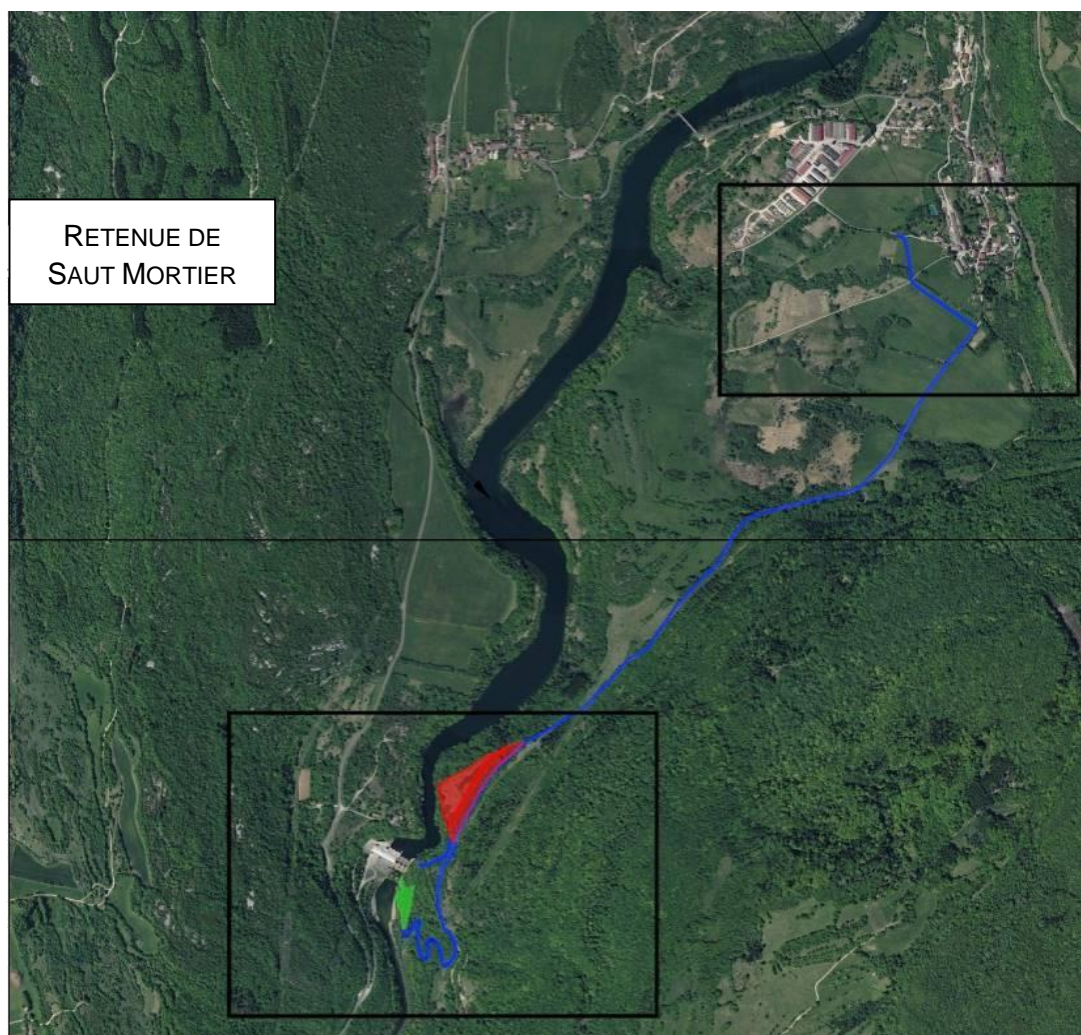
Vue en plan de la piste d'accès (bleu) et des plateformes (vert et rouge)
